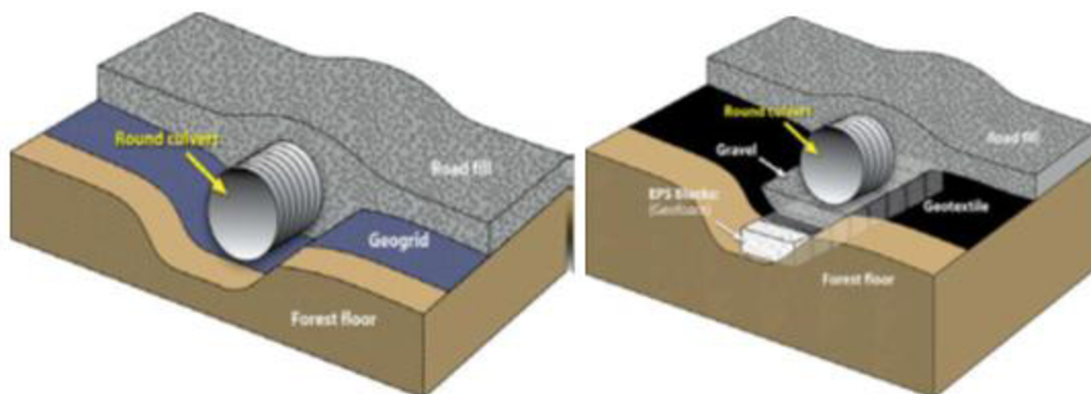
Konstrukce lože pod propustkem, vlevo poddajné potrubí, vpravo tuhé potrubí v betonovém sedle. Zdroj: (TNV 75 0211)
